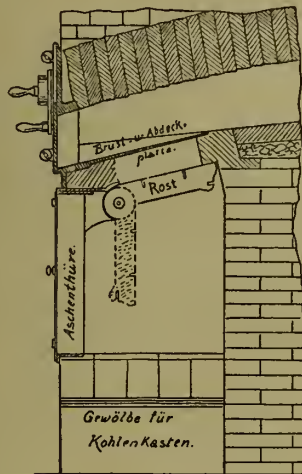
Teilweiser Längsschnitt eines Backofens für Kohlenheizung von Gebr. Oberle, Billingen.
